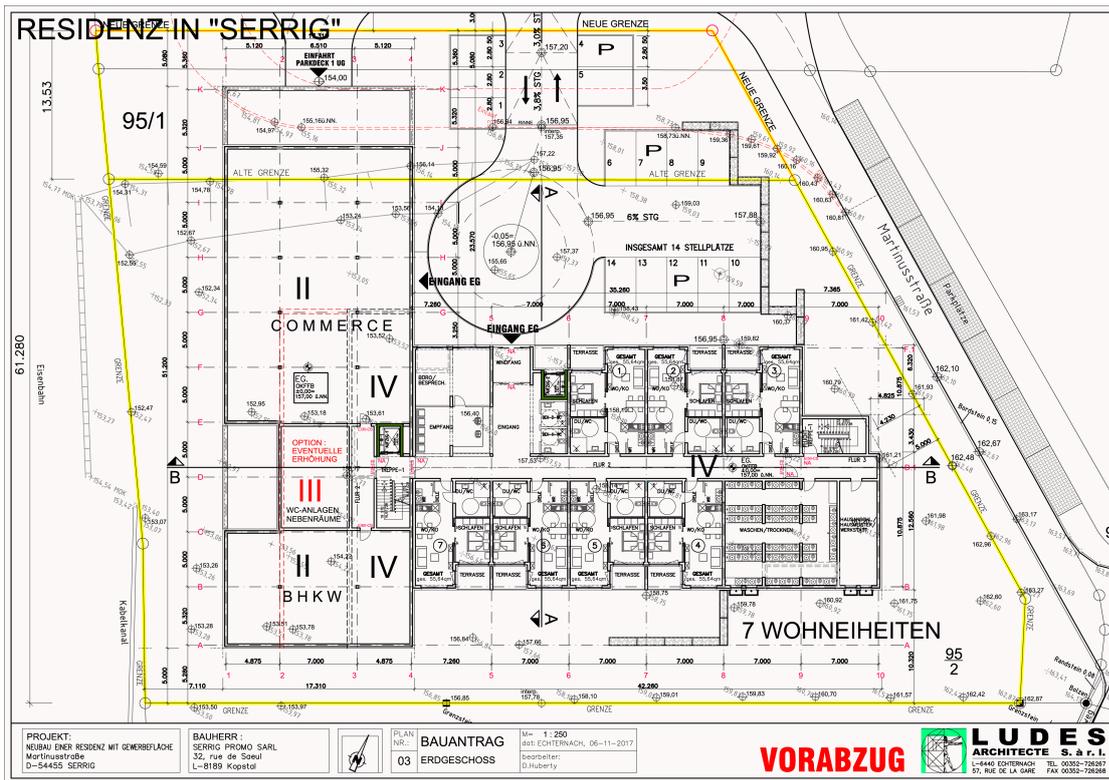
Grundriss des Bauvorhabens Planung November 2017 (ohne Maßstab)
